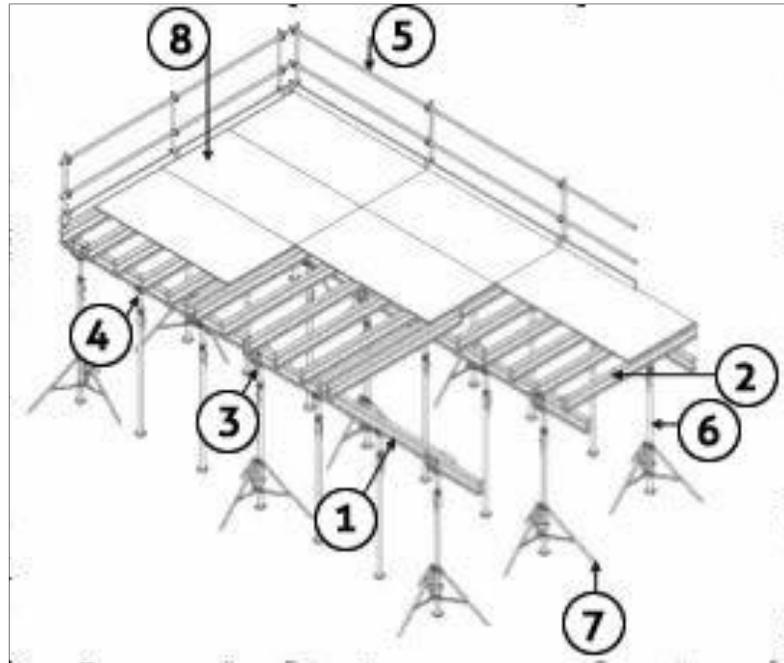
Componentes de sistema de encofrado horizontal tipo mecánico.
